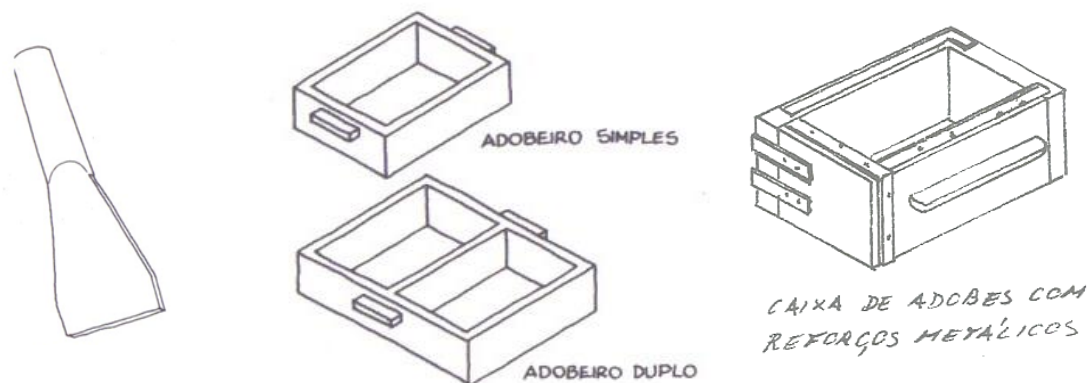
Instrumento em madeira denominado “socador” ou “sóca” [14], adobeiro em madeira [18]
